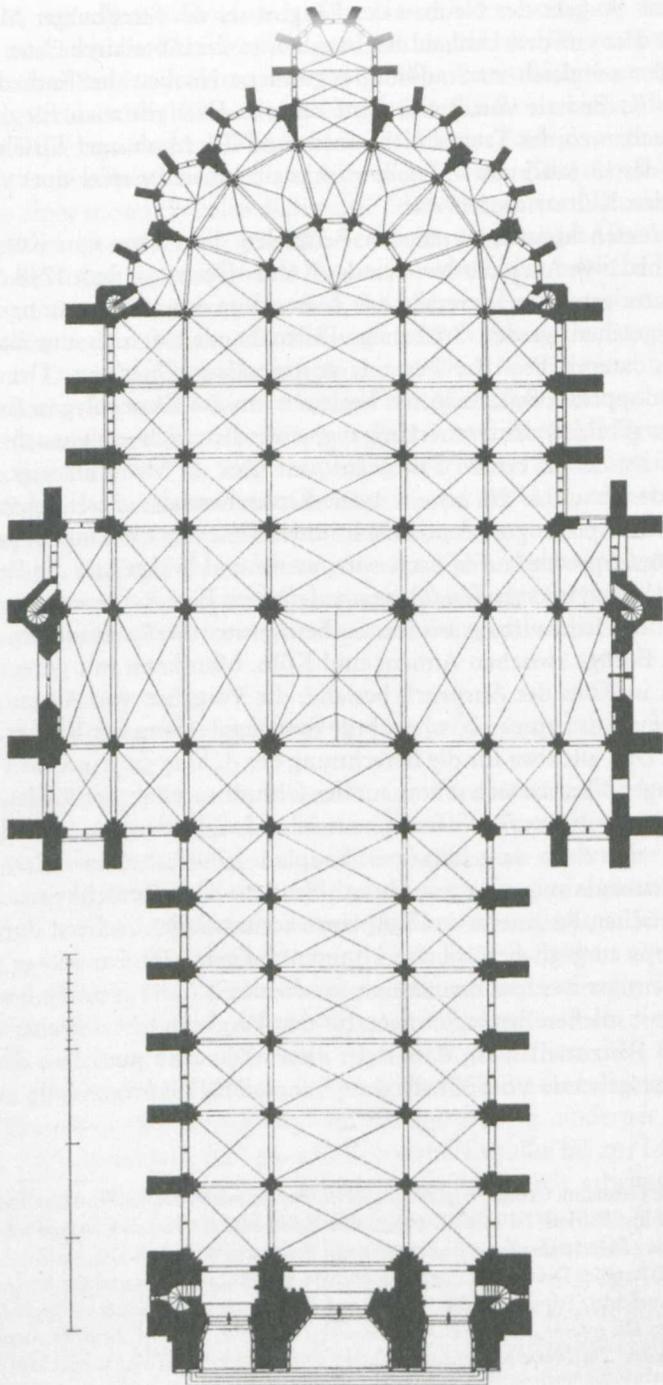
Amiens, Kathedrale, Grundriss
